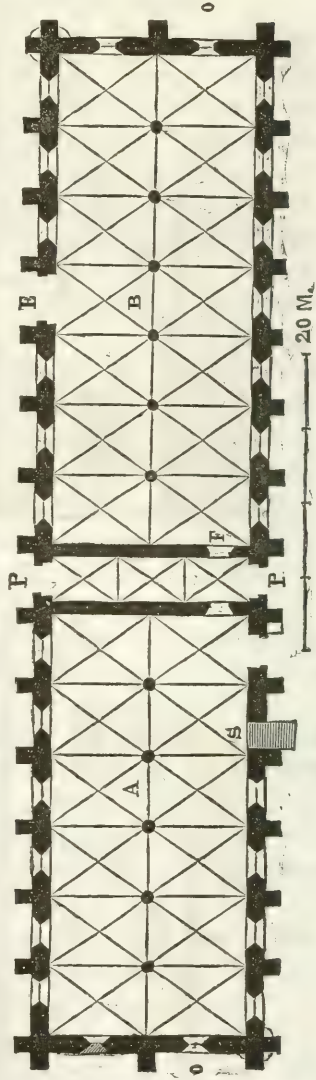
PLAN DES GRANDES SALLES DU REZ-DE-CHAUSSEE.
